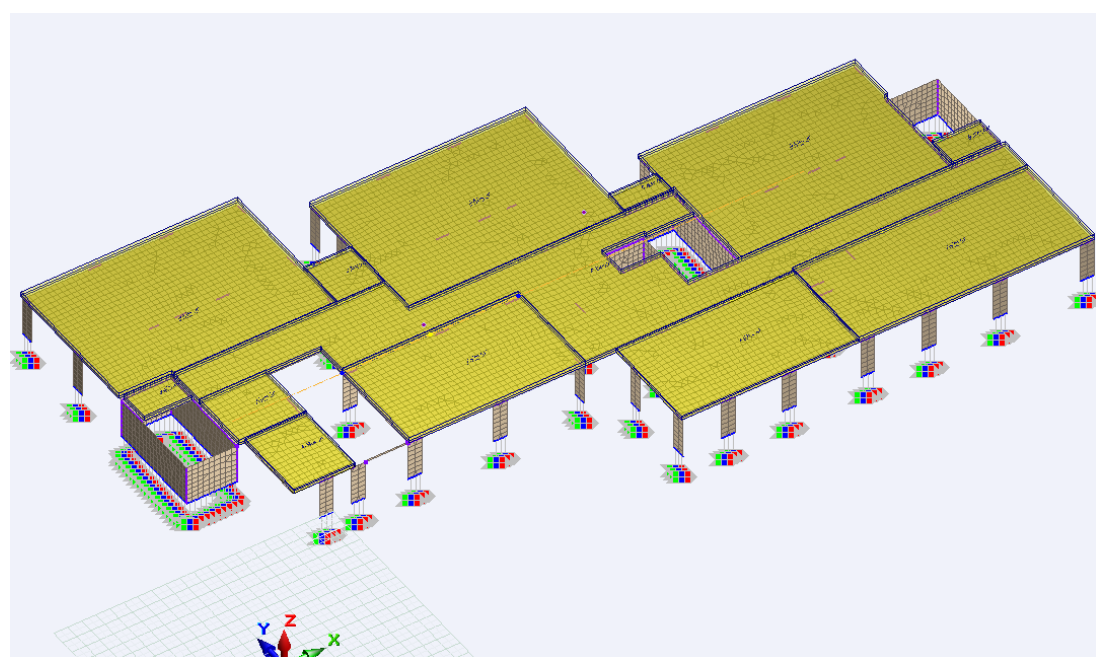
Расчетная модель перекрытия после триангуляции элементов
